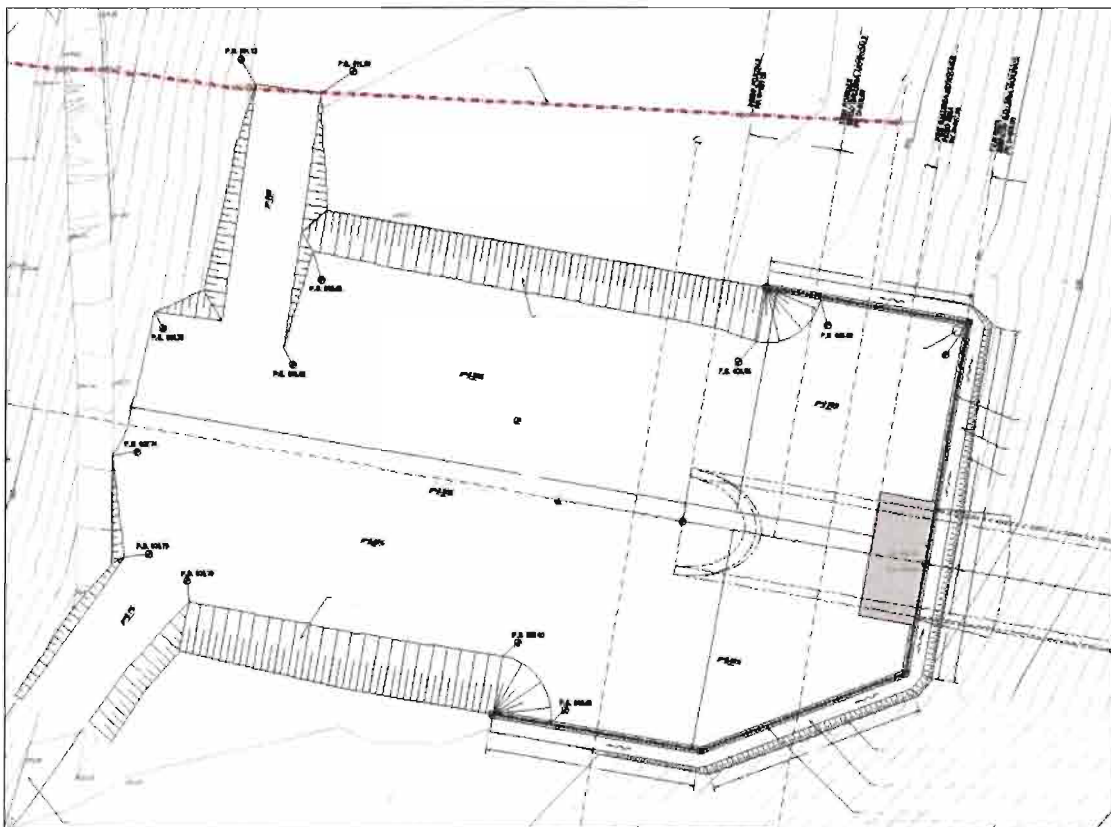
Auszug Lageplan Portal Abfahrt Klausen.
